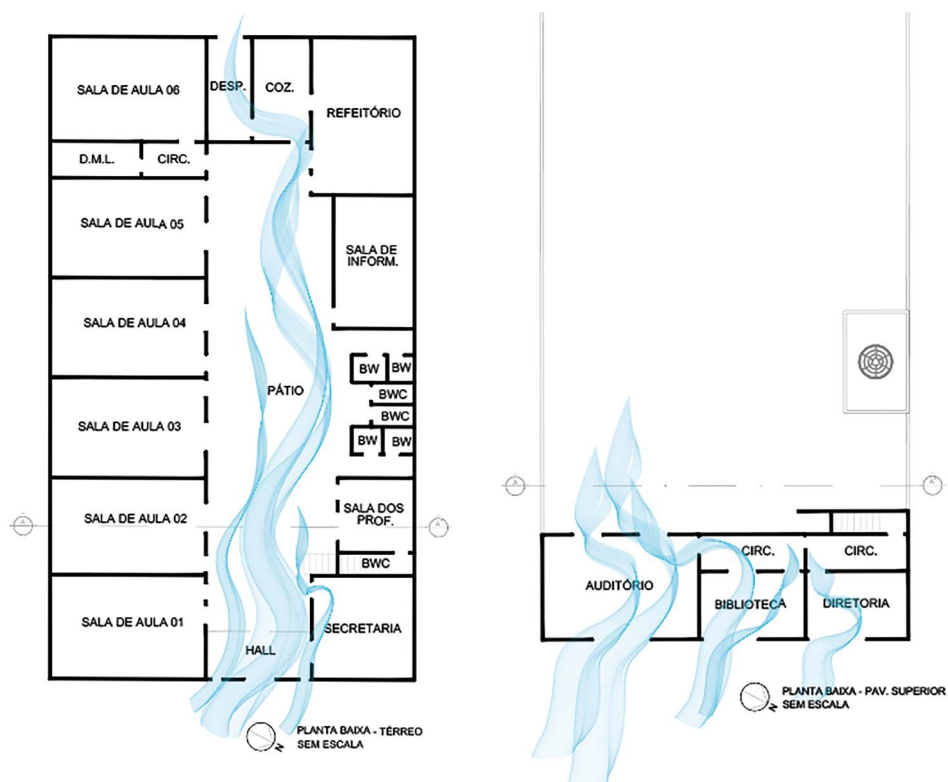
Planta baixa geral das intervenções arquitetônicas na escola A.
